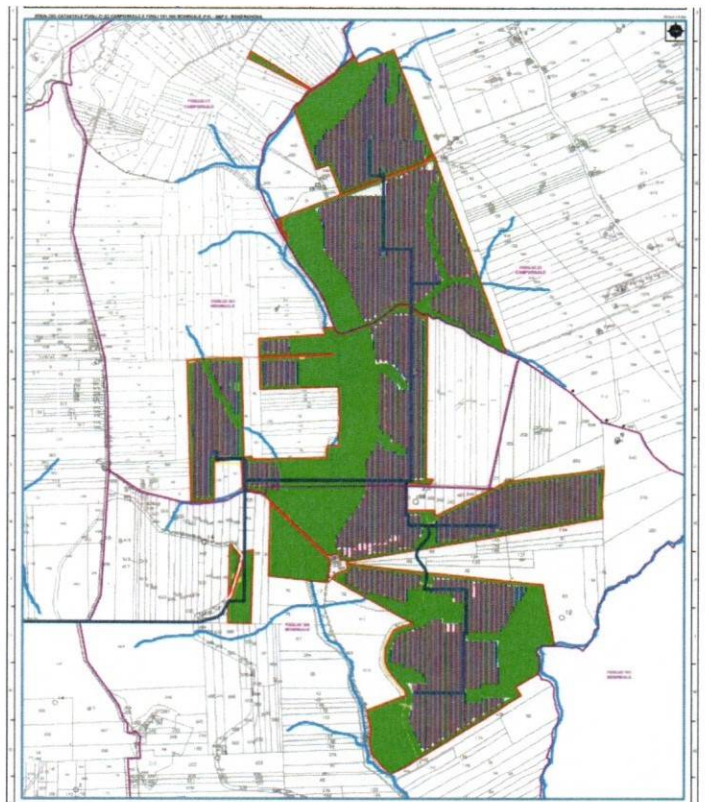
Elaborato di progetto “Carta di layout Mandranova”
